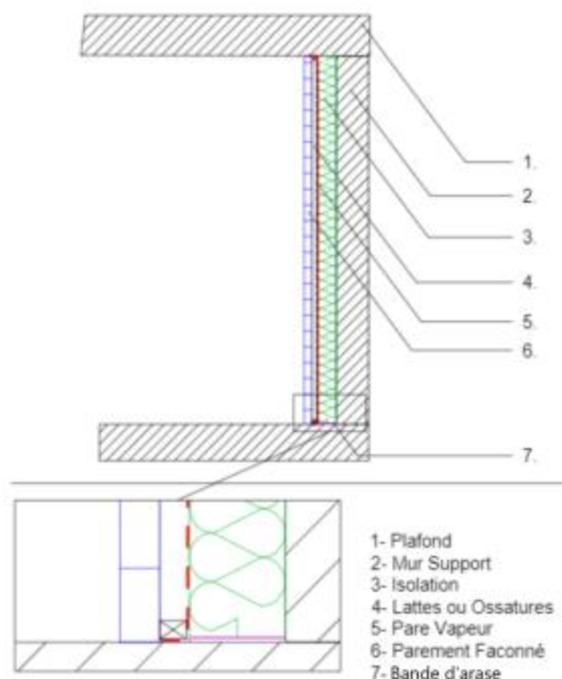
bis – Pose de la membrane pare-vapeur avec profilés fixés au plafond et au sol
